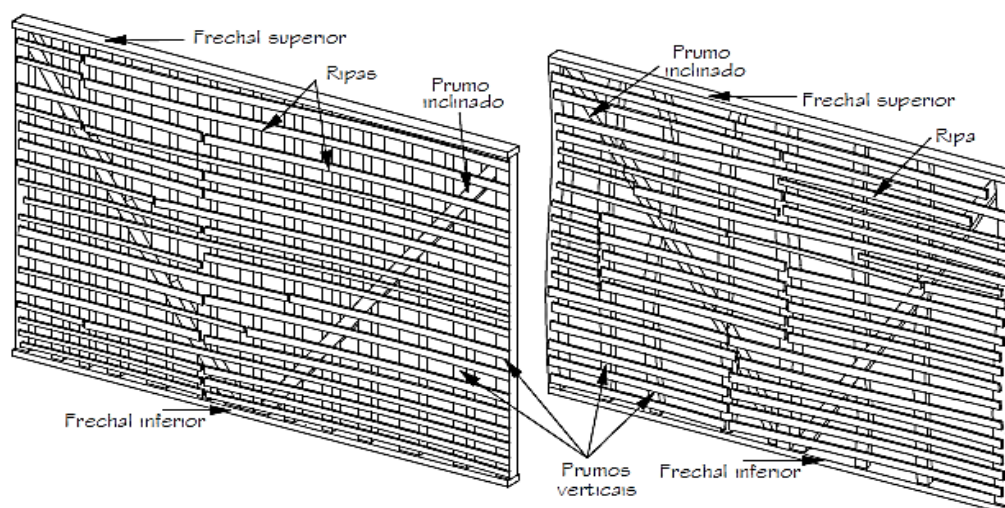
Esquema de uma parede exterior de tabique da tipologia A
